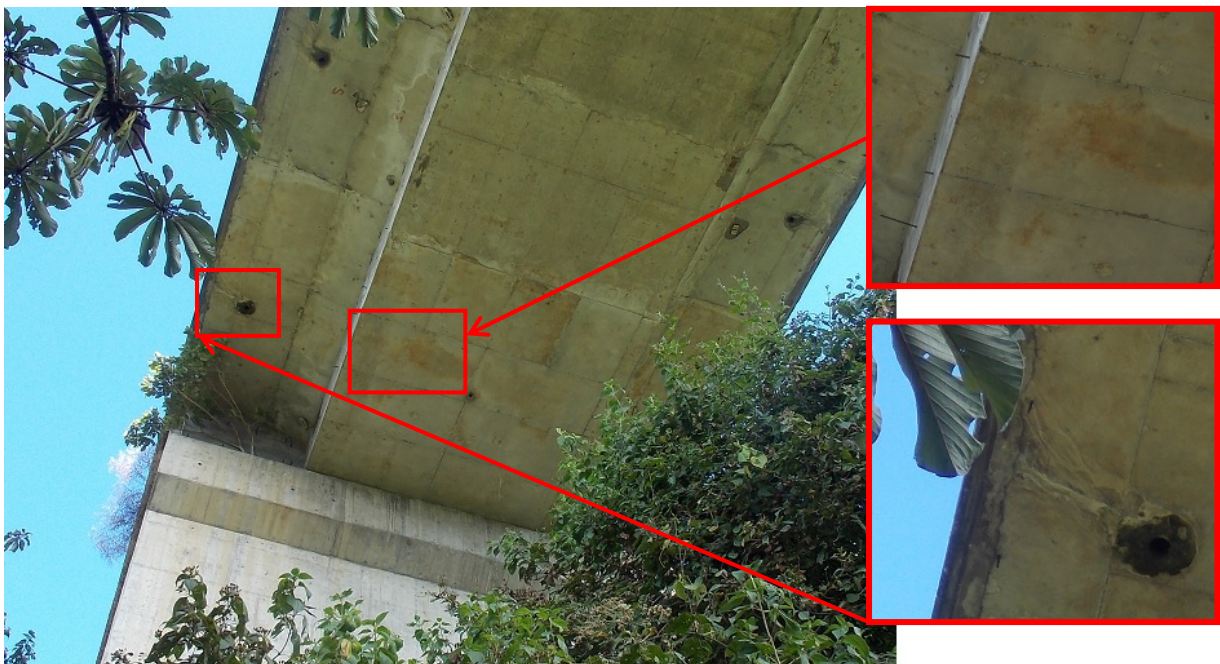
Coloración rojiza y eflorescencia en el extremo norte de viga cajón del tramo 2.
